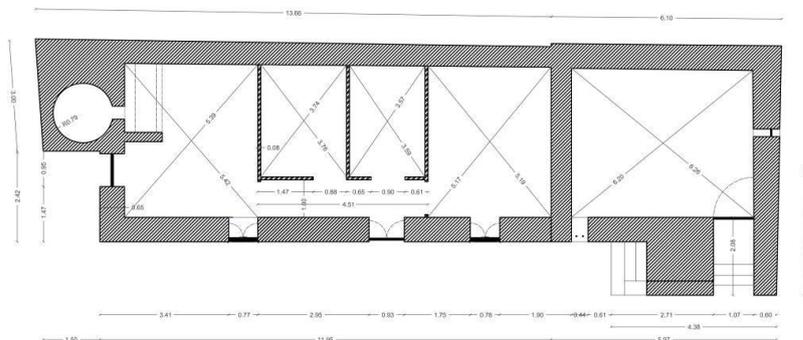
Planta do piso térreo da casa e do piso semienterrado do torreão. Elaborado pelo autor.
